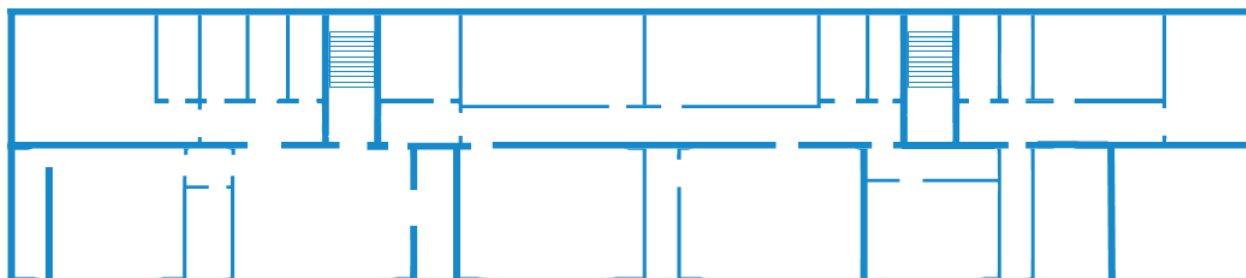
3 этаж, 1-го корпуса лицея
